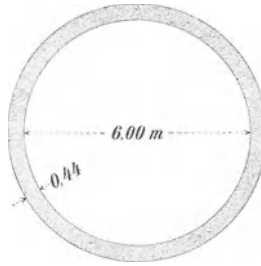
Stampfbeton (Zulässige Beanspruchung 20 kg/qcm.)
